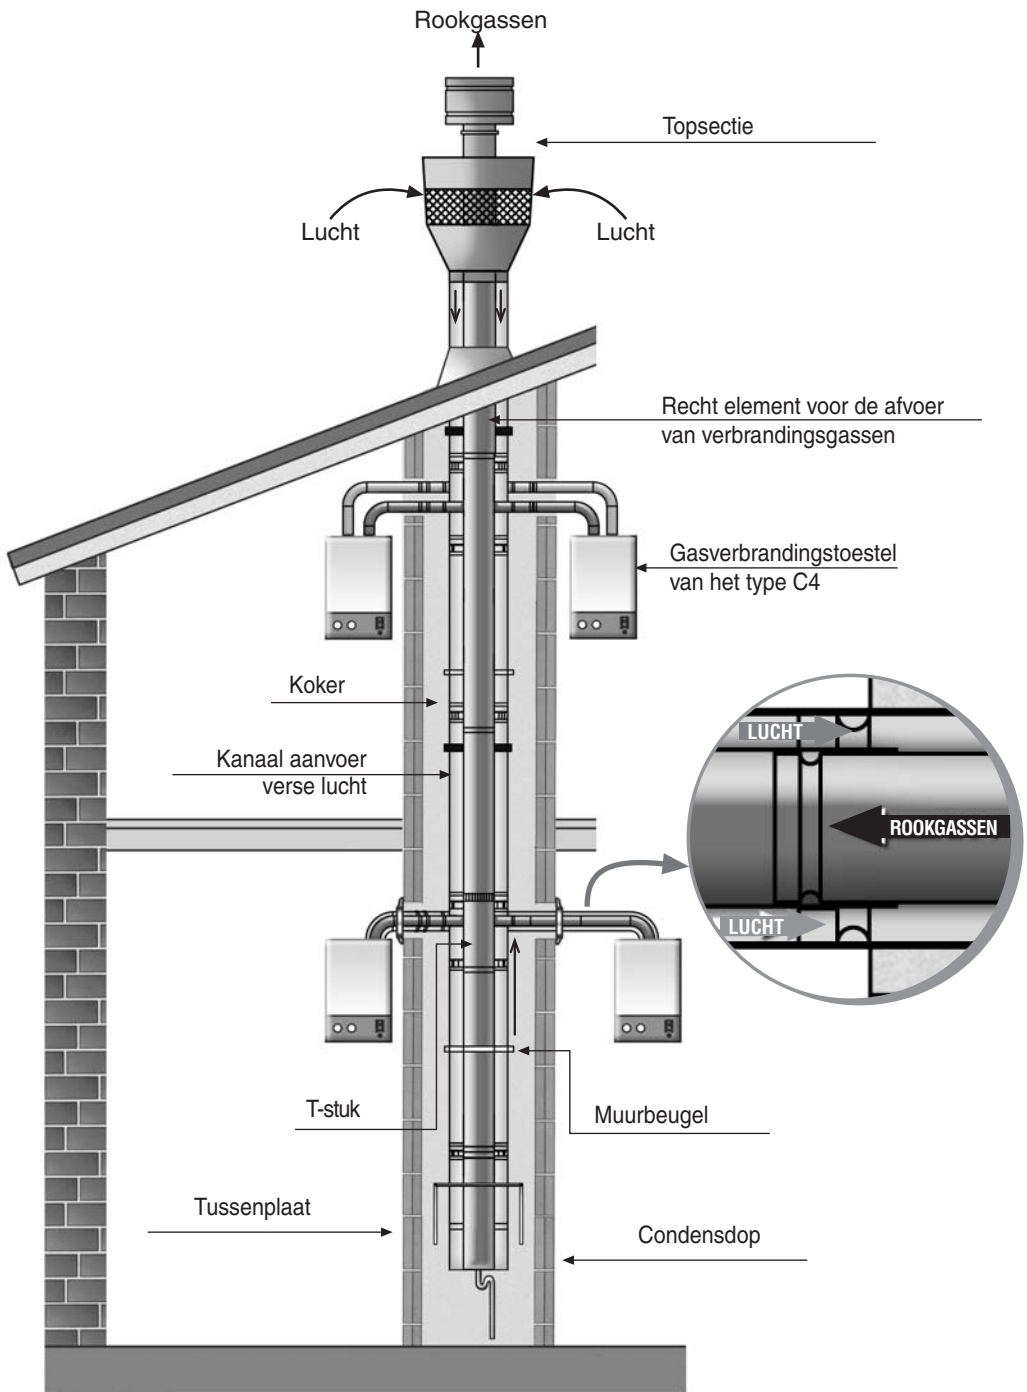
Montageschema van een schoorsteen binnen het gebouw
